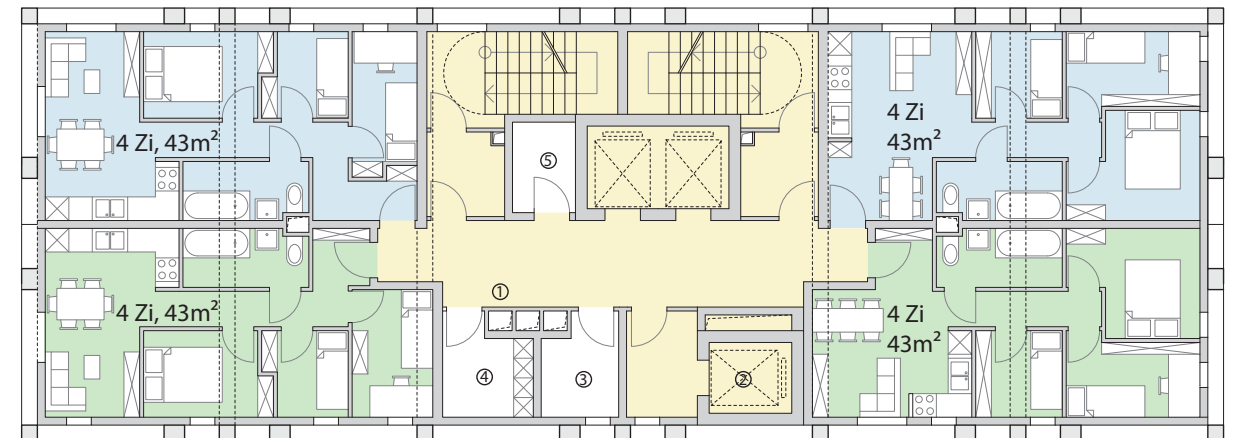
Wohnungsgrundrisse Überbauung, Varianten, Maßstab 1:200
